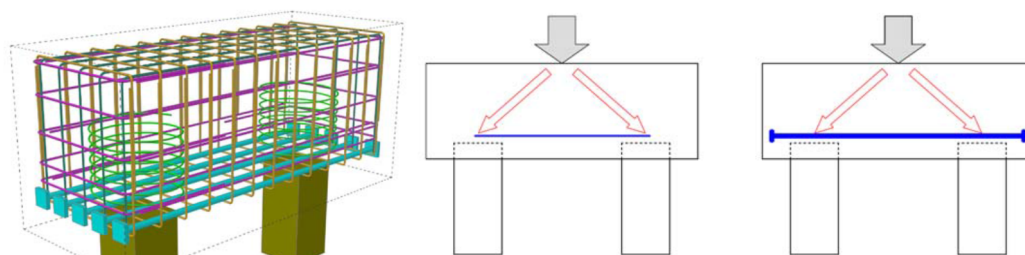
Forbedret tilgjengelighet gjennom erstatning av forankringsbøy med T-hodet armering
